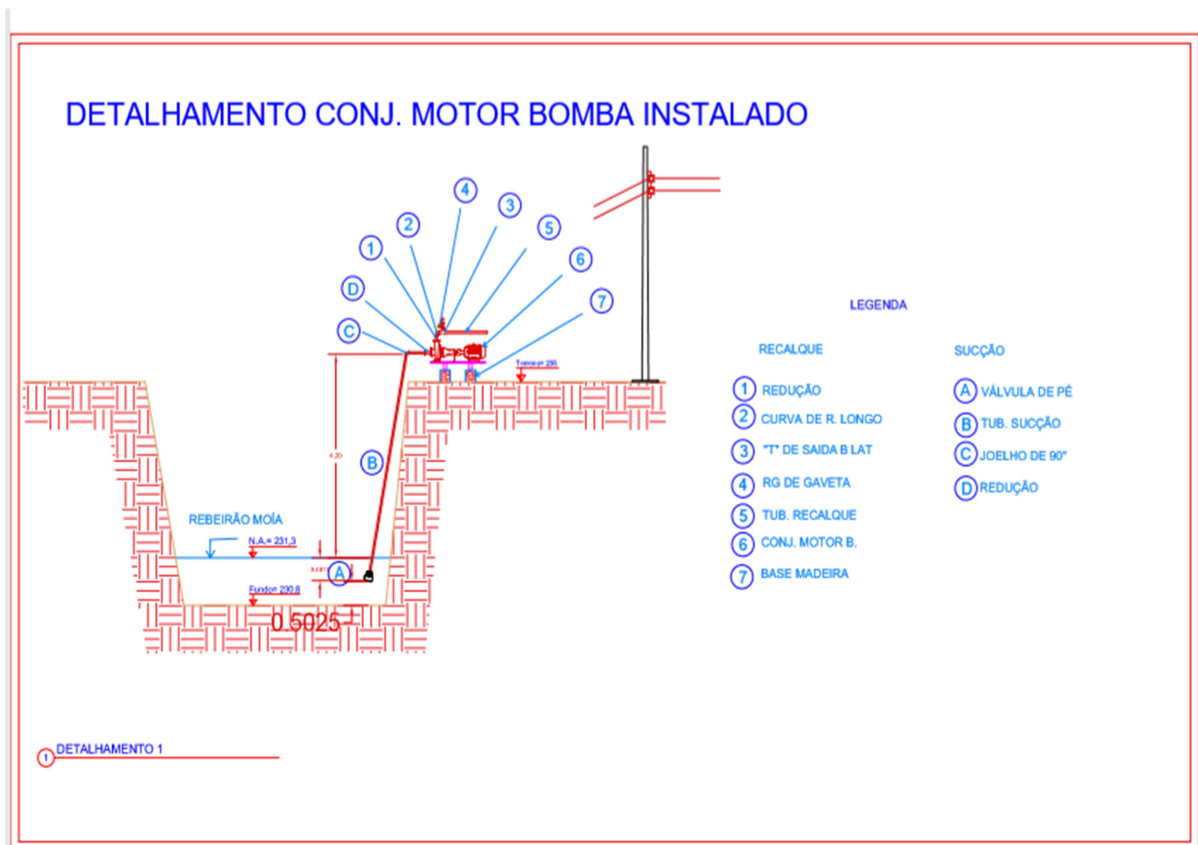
; detalhamento conj. motor bomba (Fonte; Autocad)
